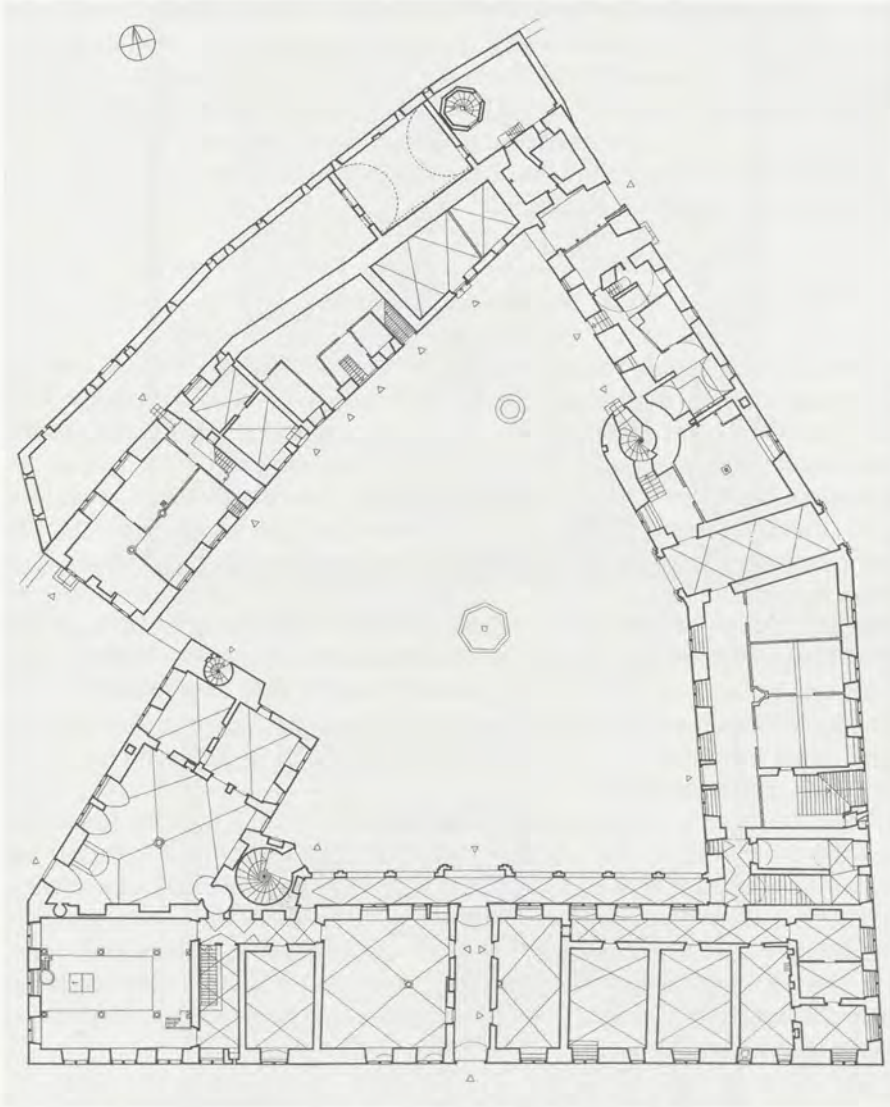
Grundriss von Schloss Weikersheim: Erdgeschoss.
